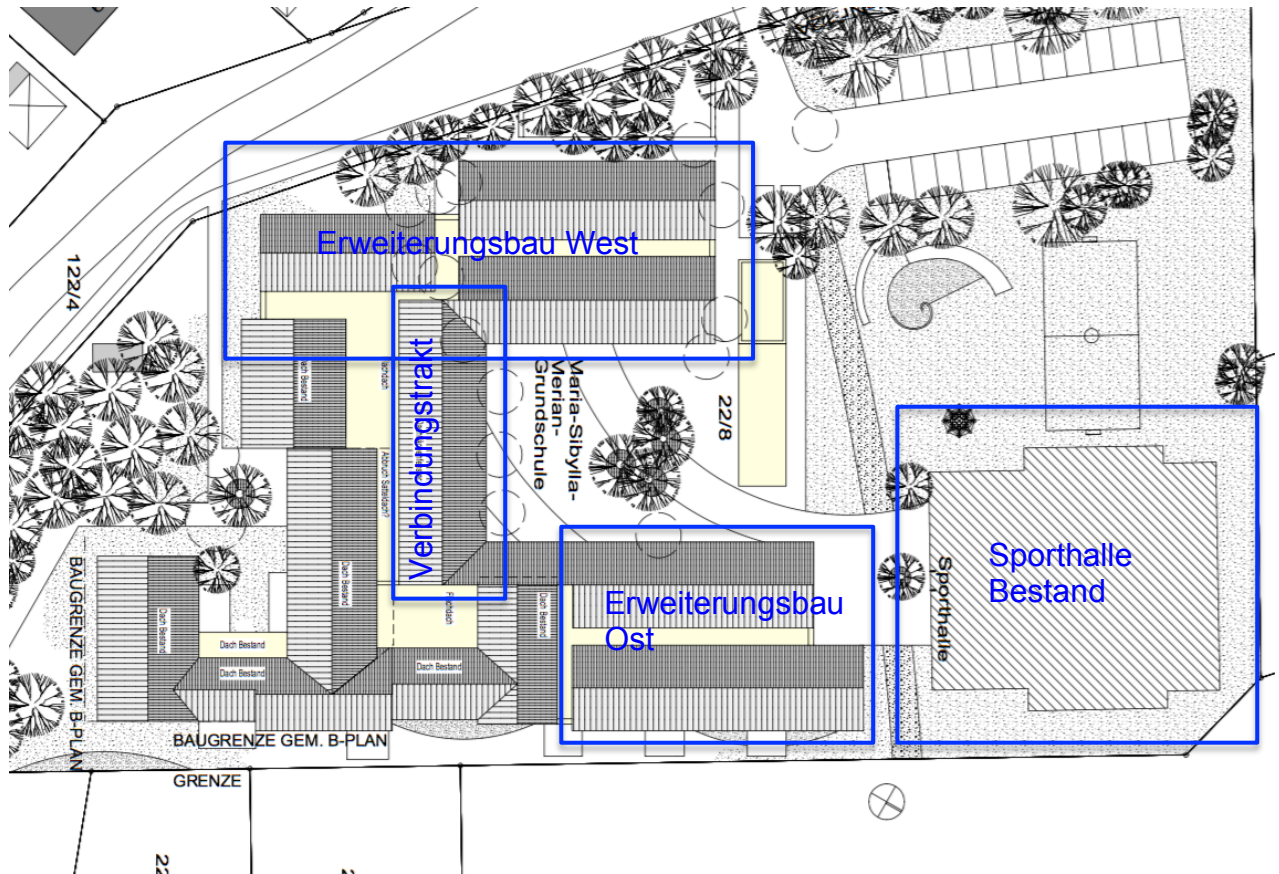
Lageplan mit blau gekennzeichneten Bauflächen [U2]
